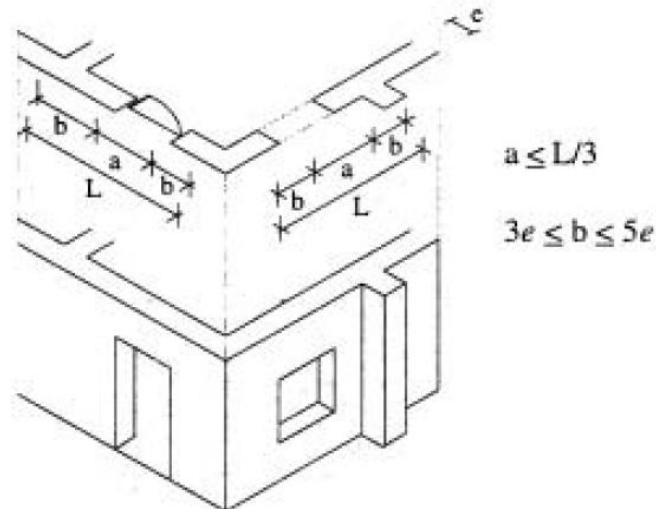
Relación de ancho de vanos 1/3 de la longitud del muro (Norma E.080 Adobe)
